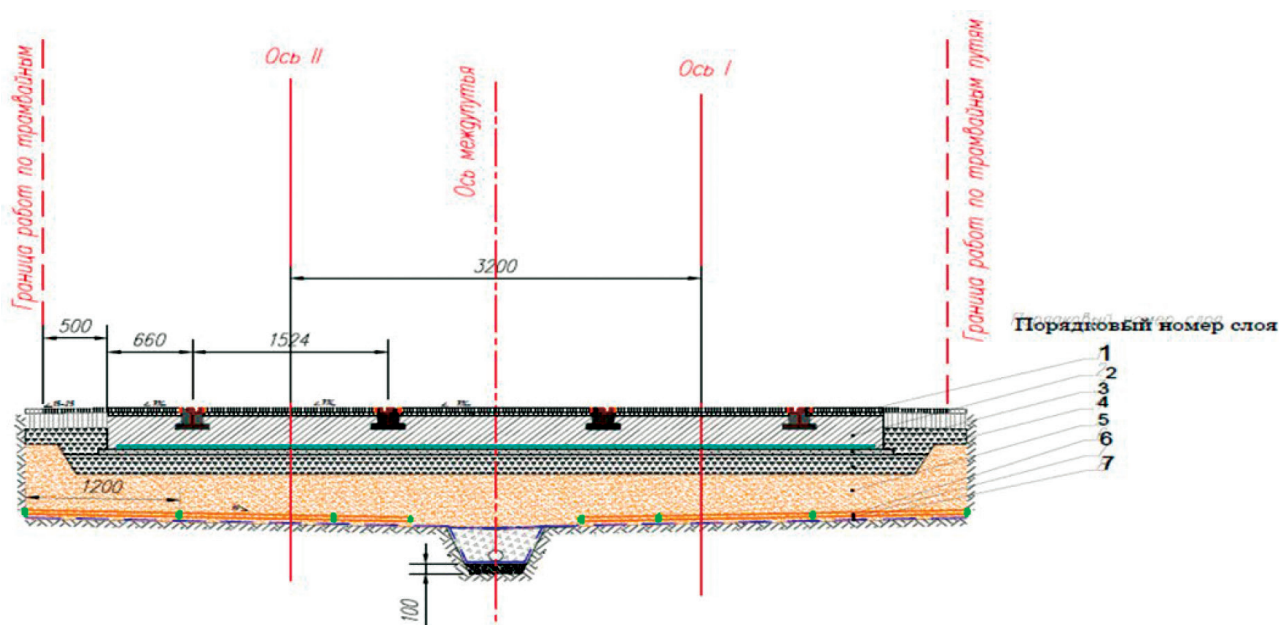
Конструкция трамвайного пути на основании из железобетонной плиты с применением порталов:
